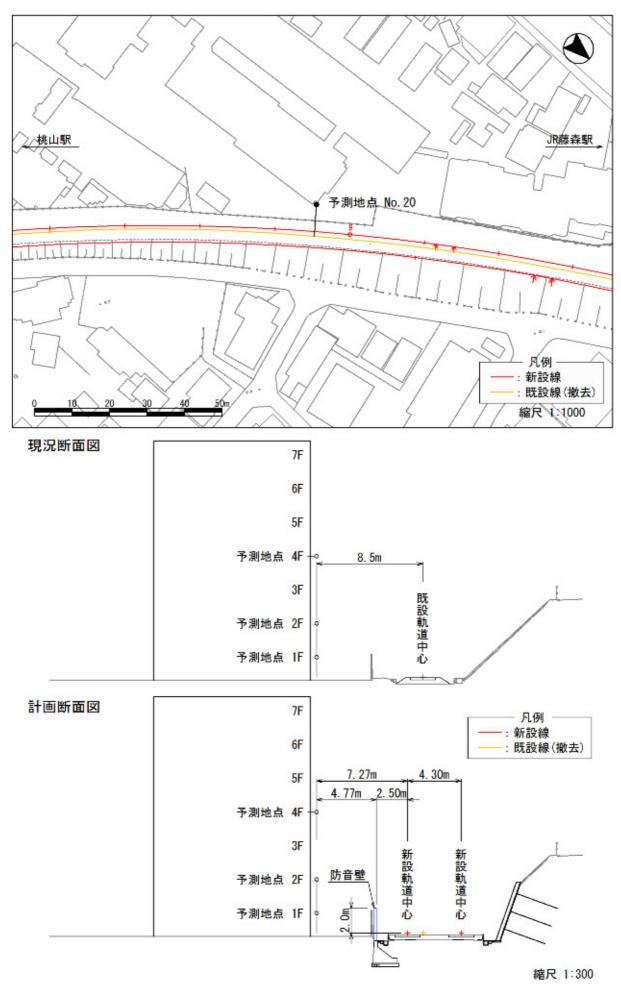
(20) 予測平面·断面図(予測地点 No. 20)
